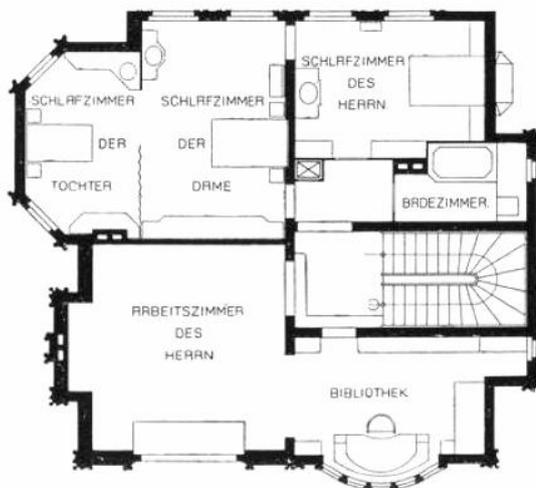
Planta do segundo piso da *Peter Behrens House*, Darmstadt, 1901
